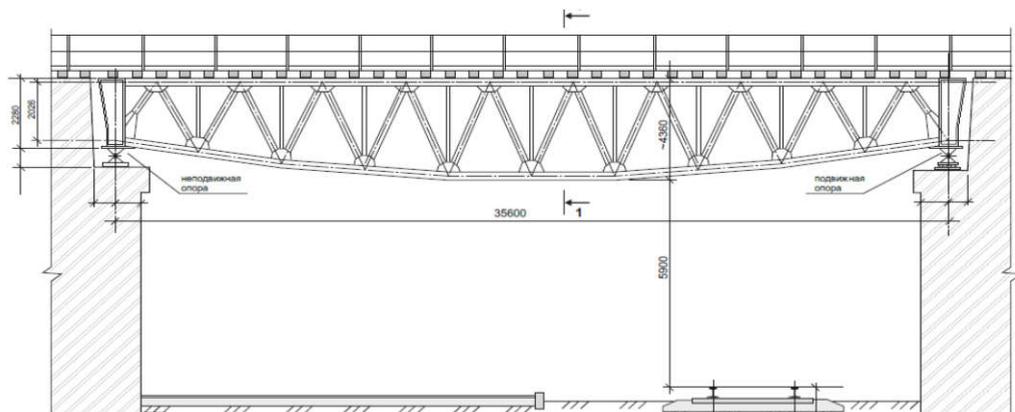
Схема расположения конструкций пролетного строения путепровода
